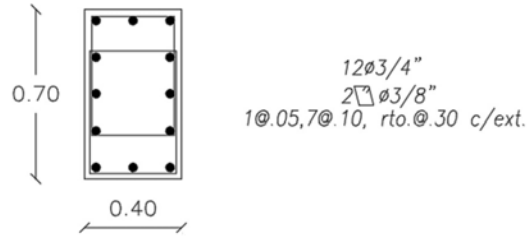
Armado de acero de la columna C-1 del 4º al 6º piso
